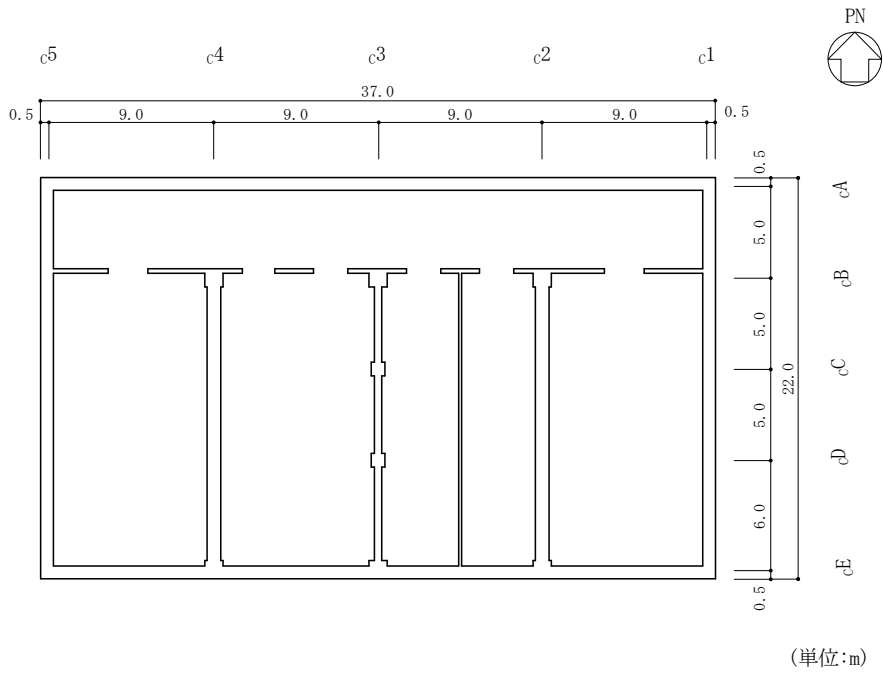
(1) 制御室建物の概略平面図 (EL 1.6m)
